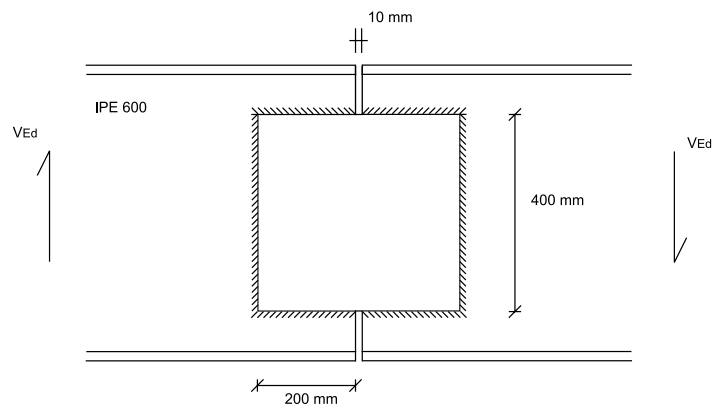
Ligação por soldadura de chapas cobre-juntas
